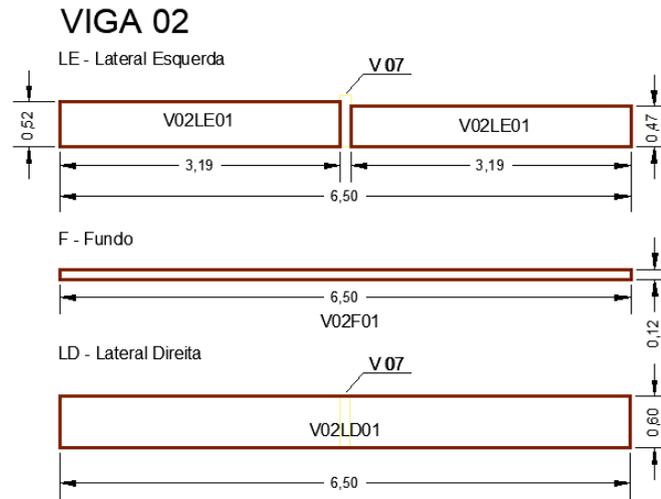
Detalhamento inicial das cofragens das Vigas V2
